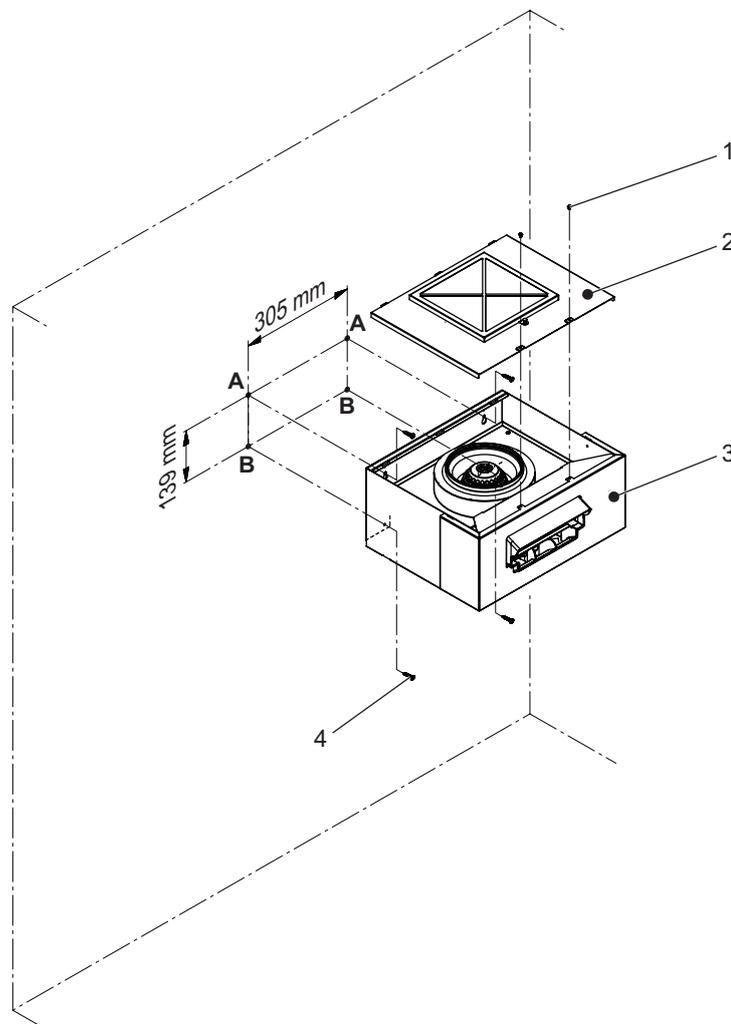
Installation des Dampfadapters im Ventilationsgerät
